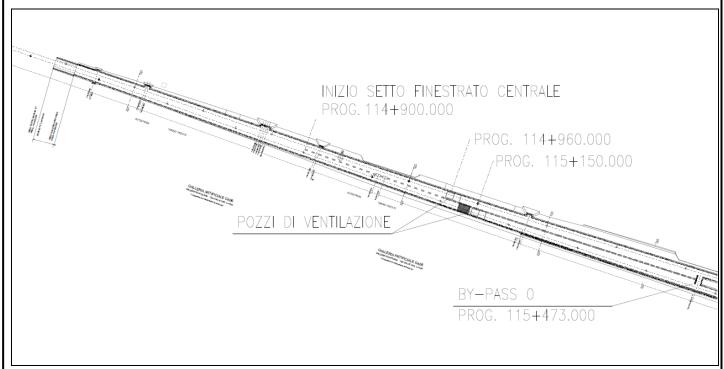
Stralcio di planimetria, zona interessata dalla disconnessione aeraulica
